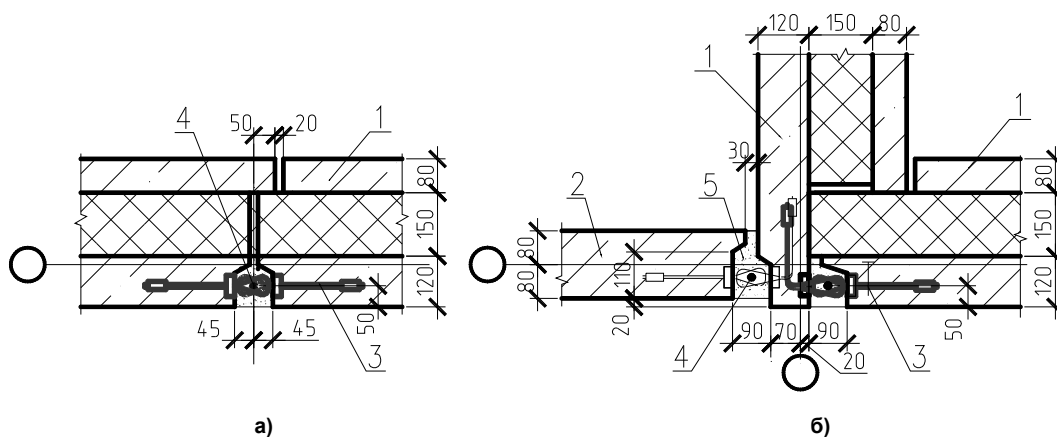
Линейный узел сопряжения наружных панелей (а), Т-образный узел сопряжения внутренней панели с наружными (б): 1 – наружная панель; 2 – внутренняя панель; 3 – тросовая петля; 4 – арматурный стержень Ø16 мм АIII; 5 – бетон омоноличивания
